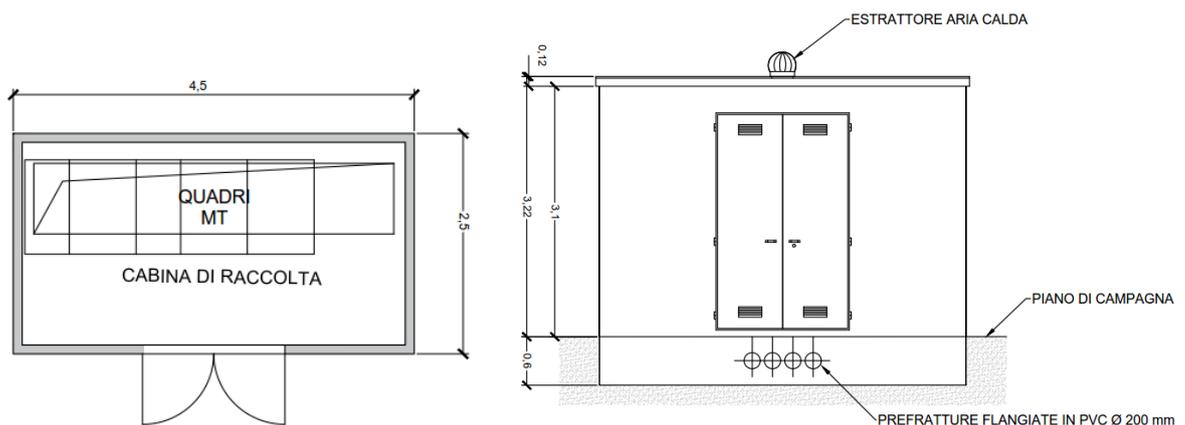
vista in pianta e in prospettiva della cabina di raccolta installata in campo. Viste tipo.
